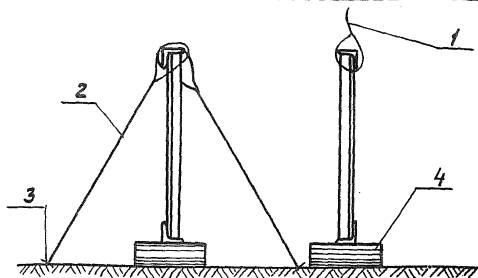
Схема строповки боковой грани стойки опоры типа ПС 750:
